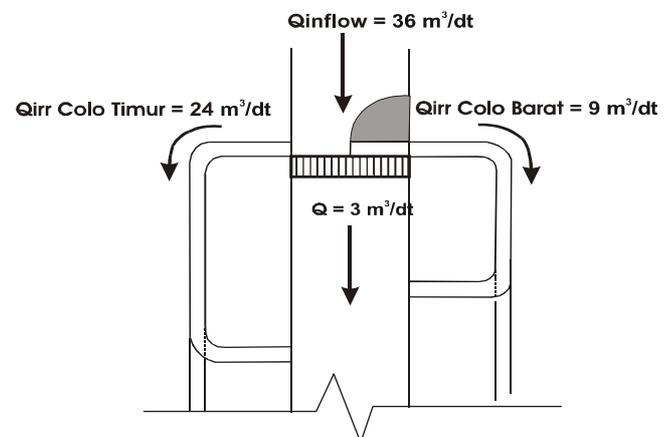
Denah situasi model hidraulik kantong lumpur Bendung Colo
